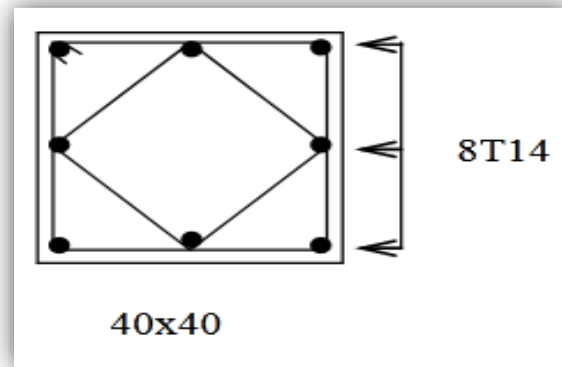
Schéma de ferrailage des poteaux (40x40) cm.
